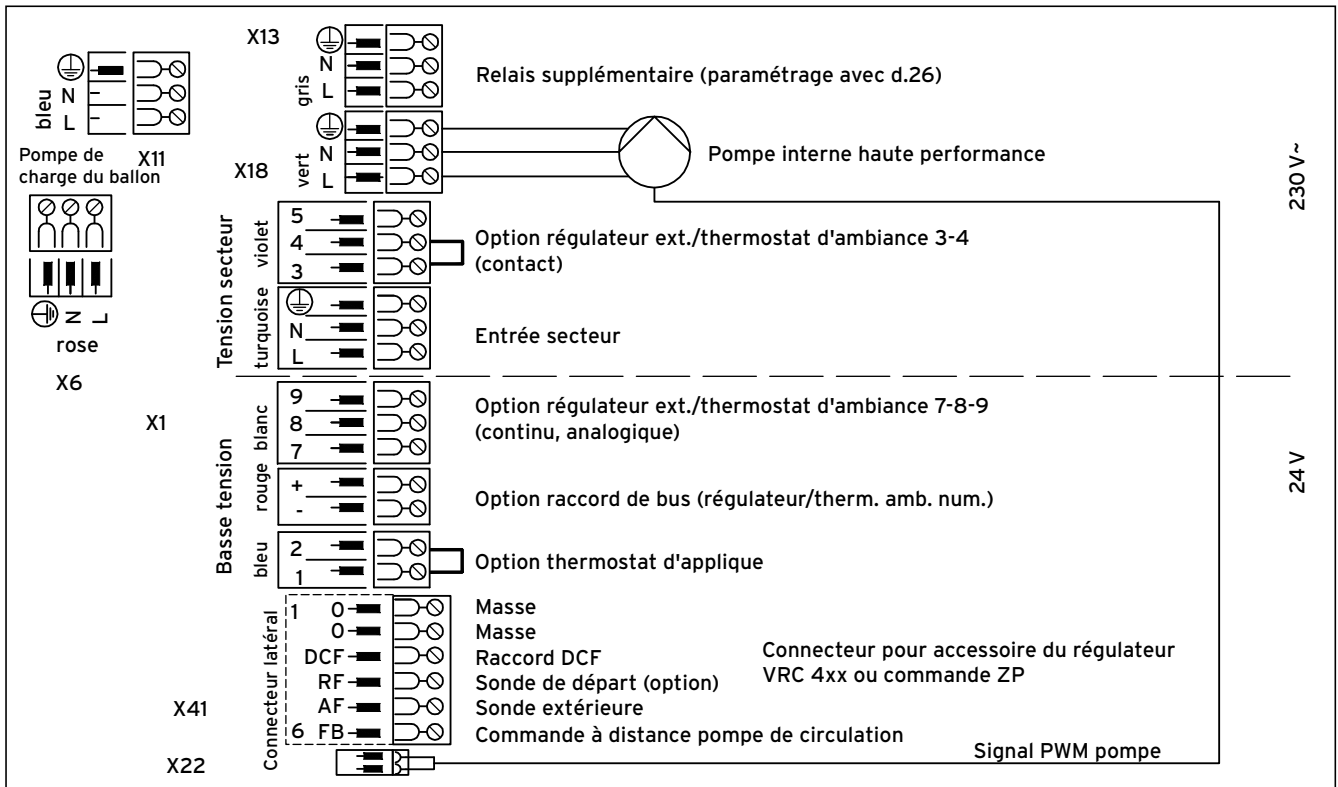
Plan de raccordement de l'appareil ecoTEC exclusiv (suite)
